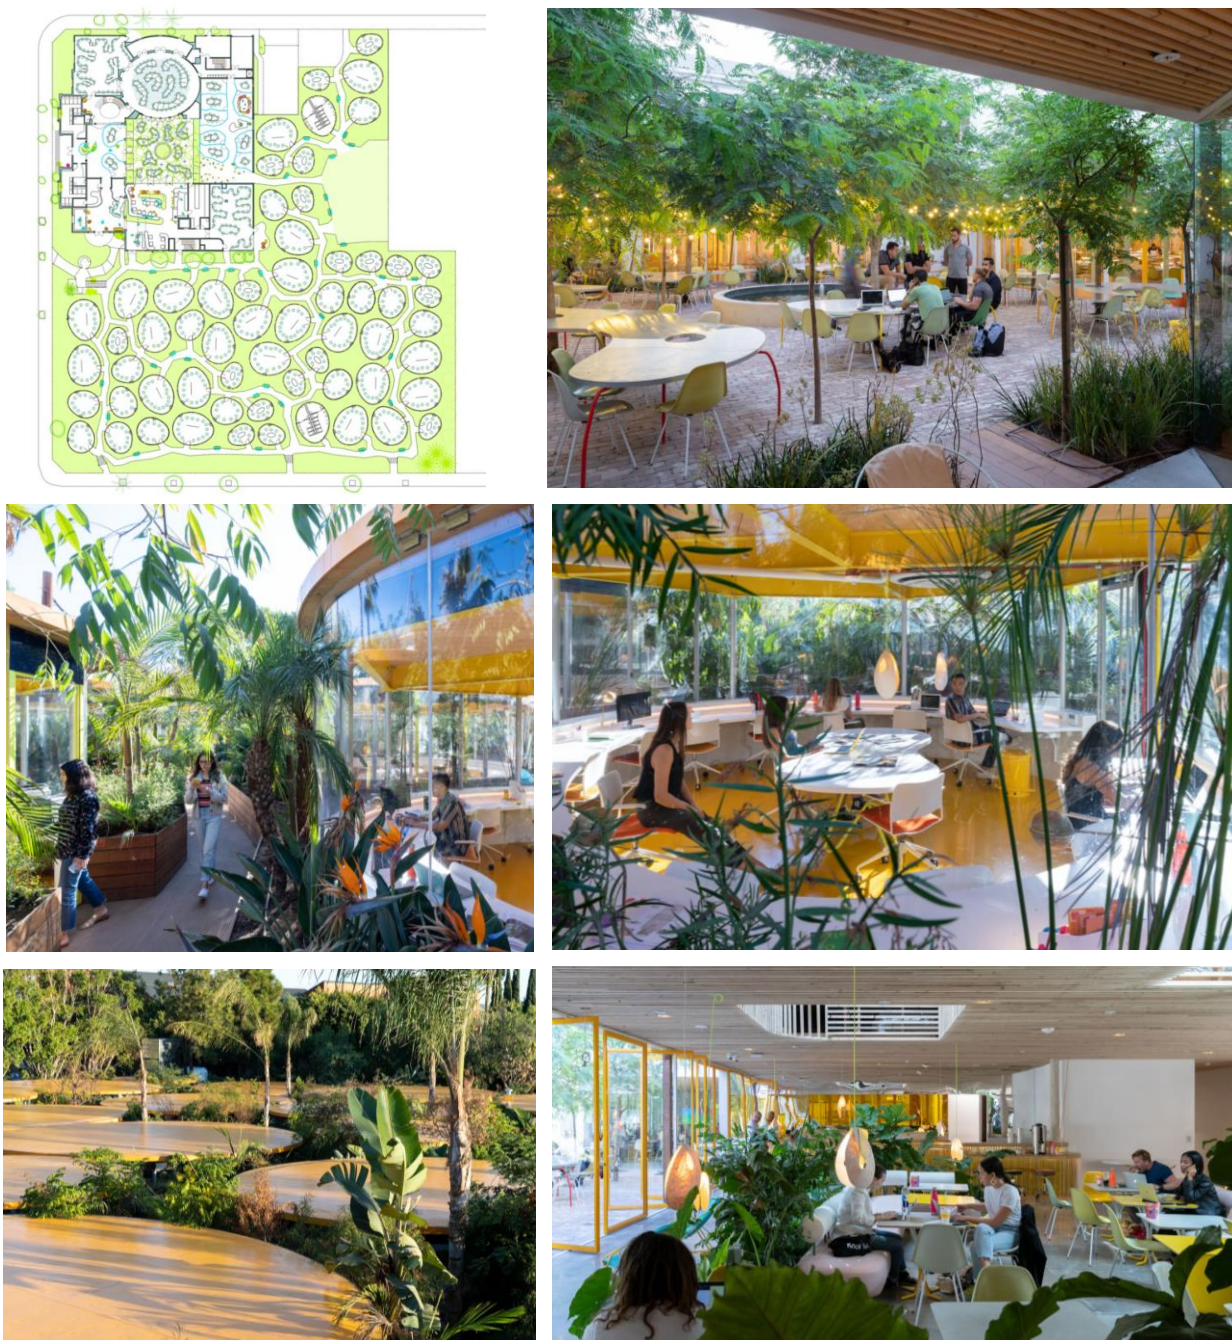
Planta e fotografias do interior e exterior. Fonte: Archdaily.
